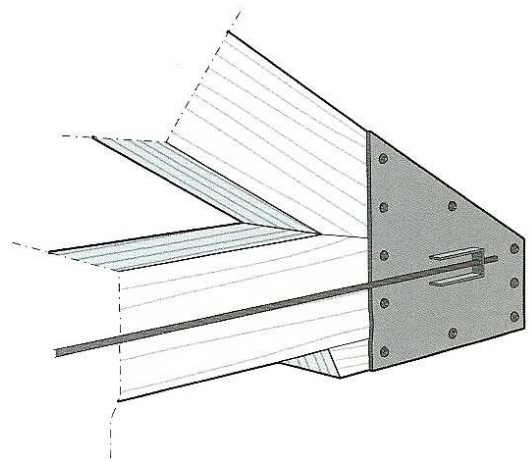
Aplicação de tirante e chapa metálica para reforço de ligação de perna com linha de asna, (Fonte [31])
